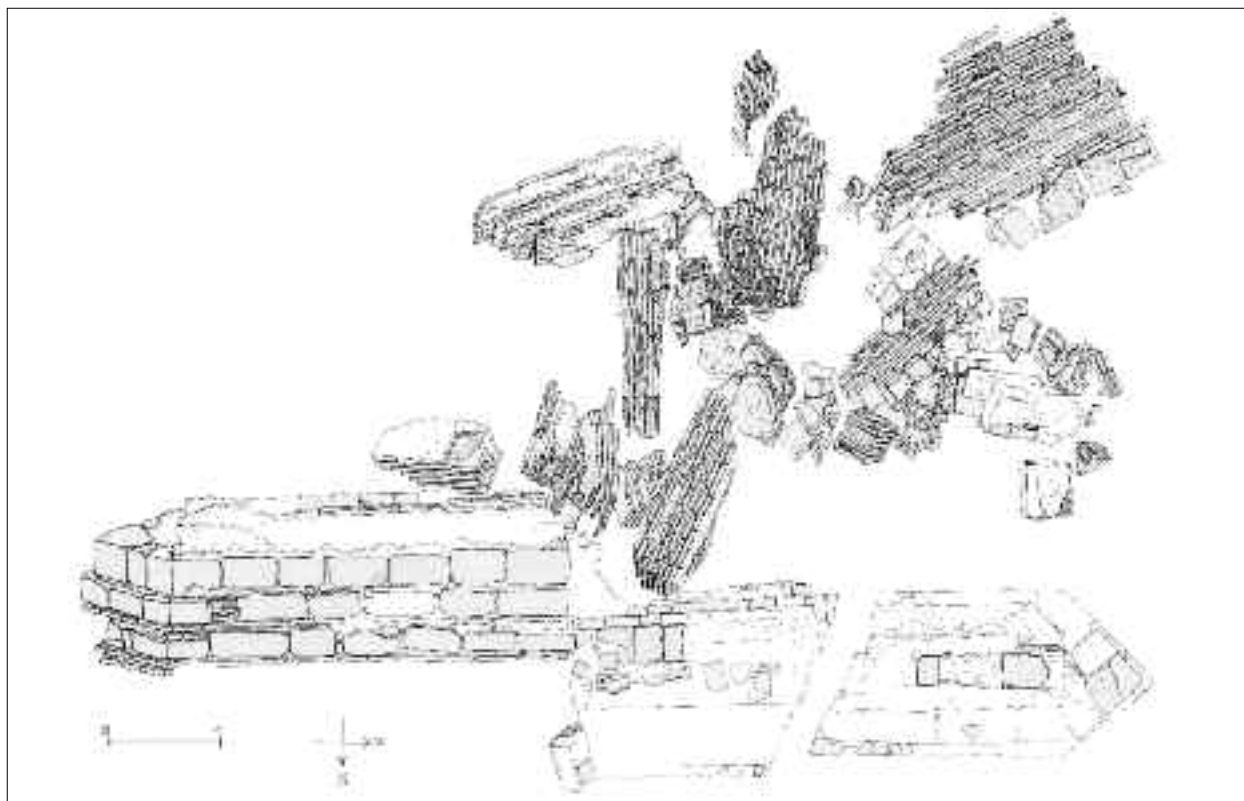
PLAN DE L'EFFONDREMENT DE LA PILE D, sondage 1.
